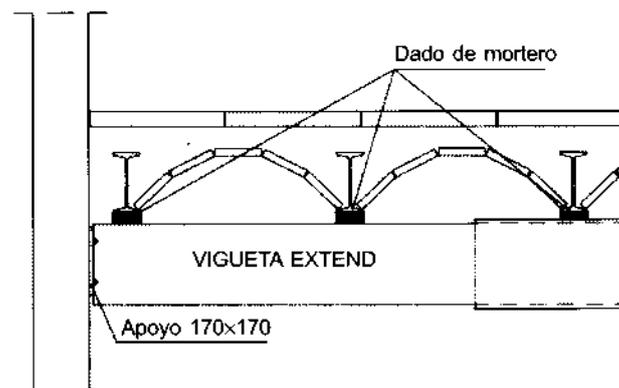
Refuerzo de forjado de viguetas de hierro. Aparte luz o viga riñonera.
